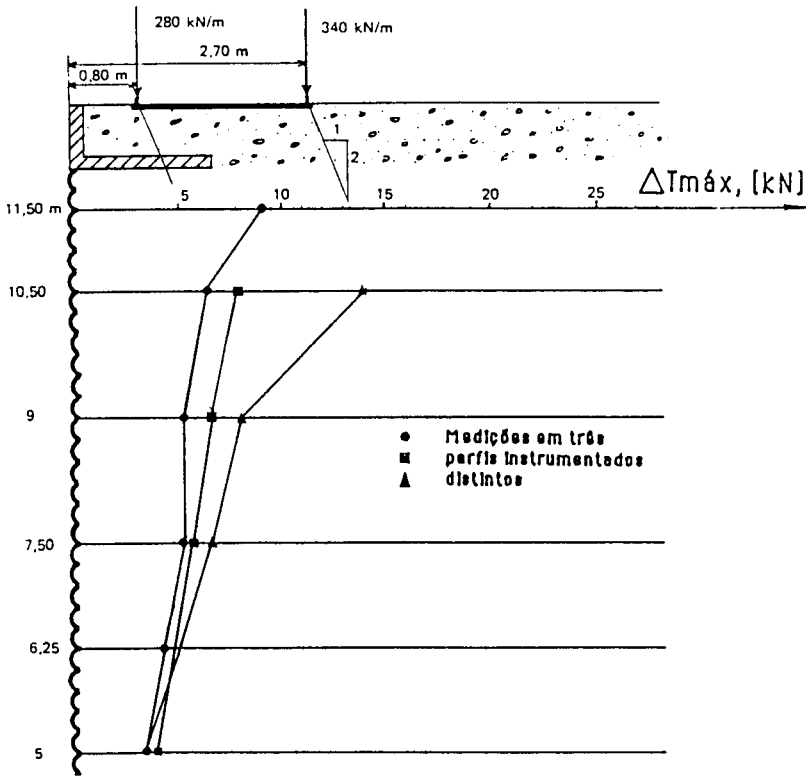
Muro de Dunkerque (Corté, 1977): máximos incrementos de tracção nas armaduras devidos à sobrecarga
